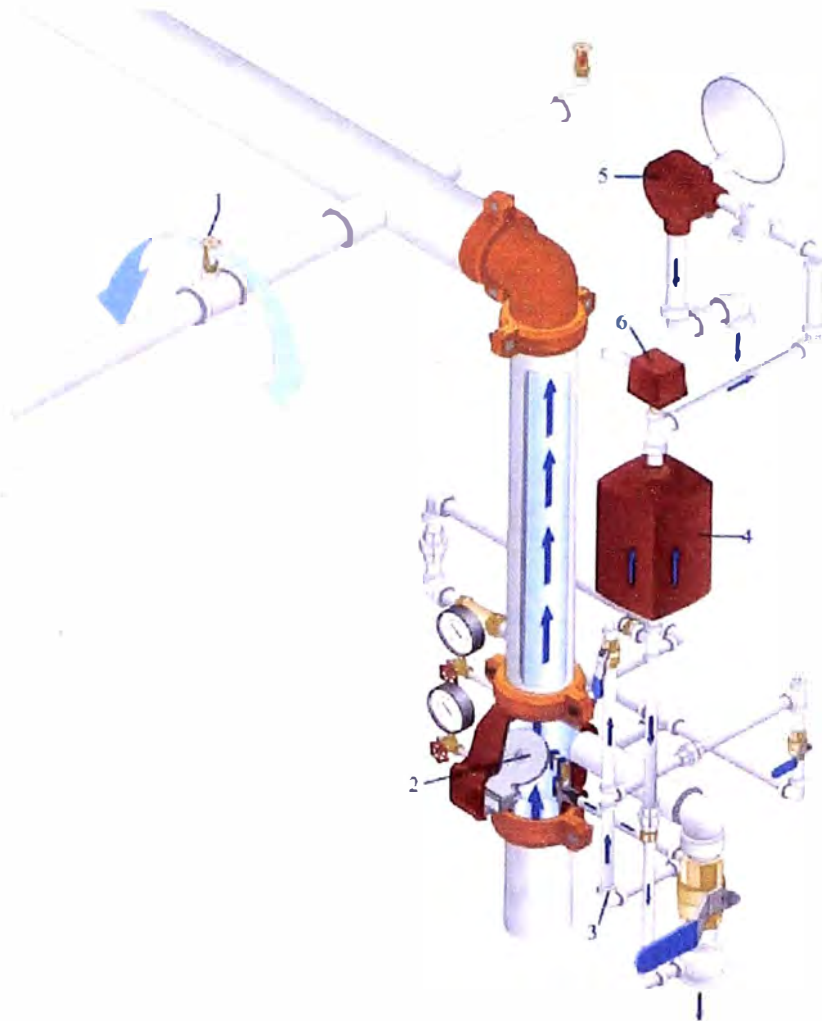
Válvula de alarma y drenaje para sistemas de tubería húmeda
